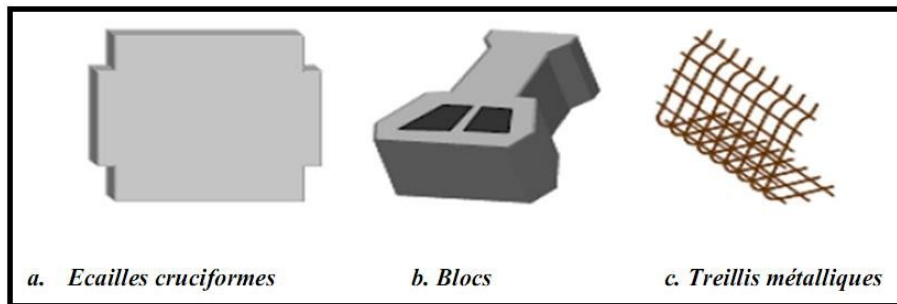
Panneaux ou écailles de la façade du mur.
